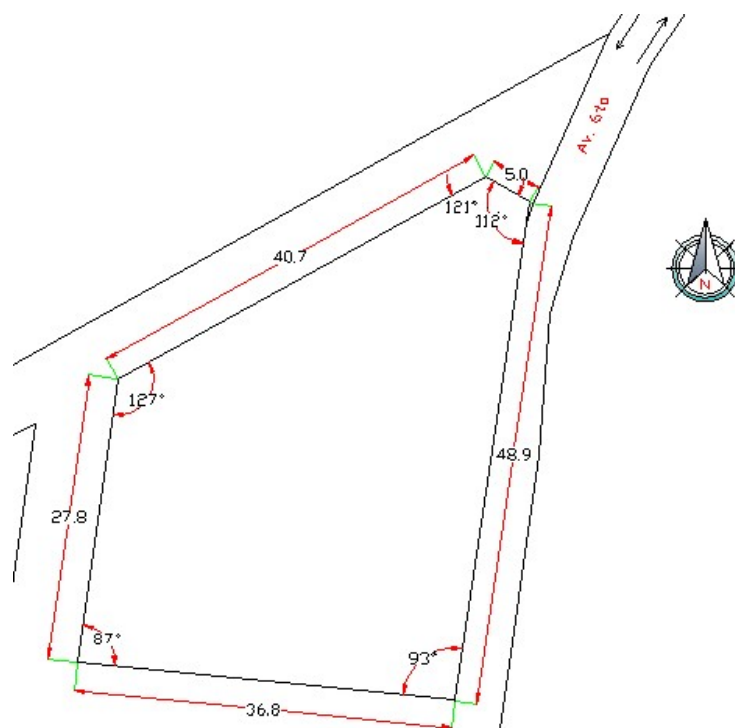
Planimetría del terreno para la obra. Área Total 1500 m².
